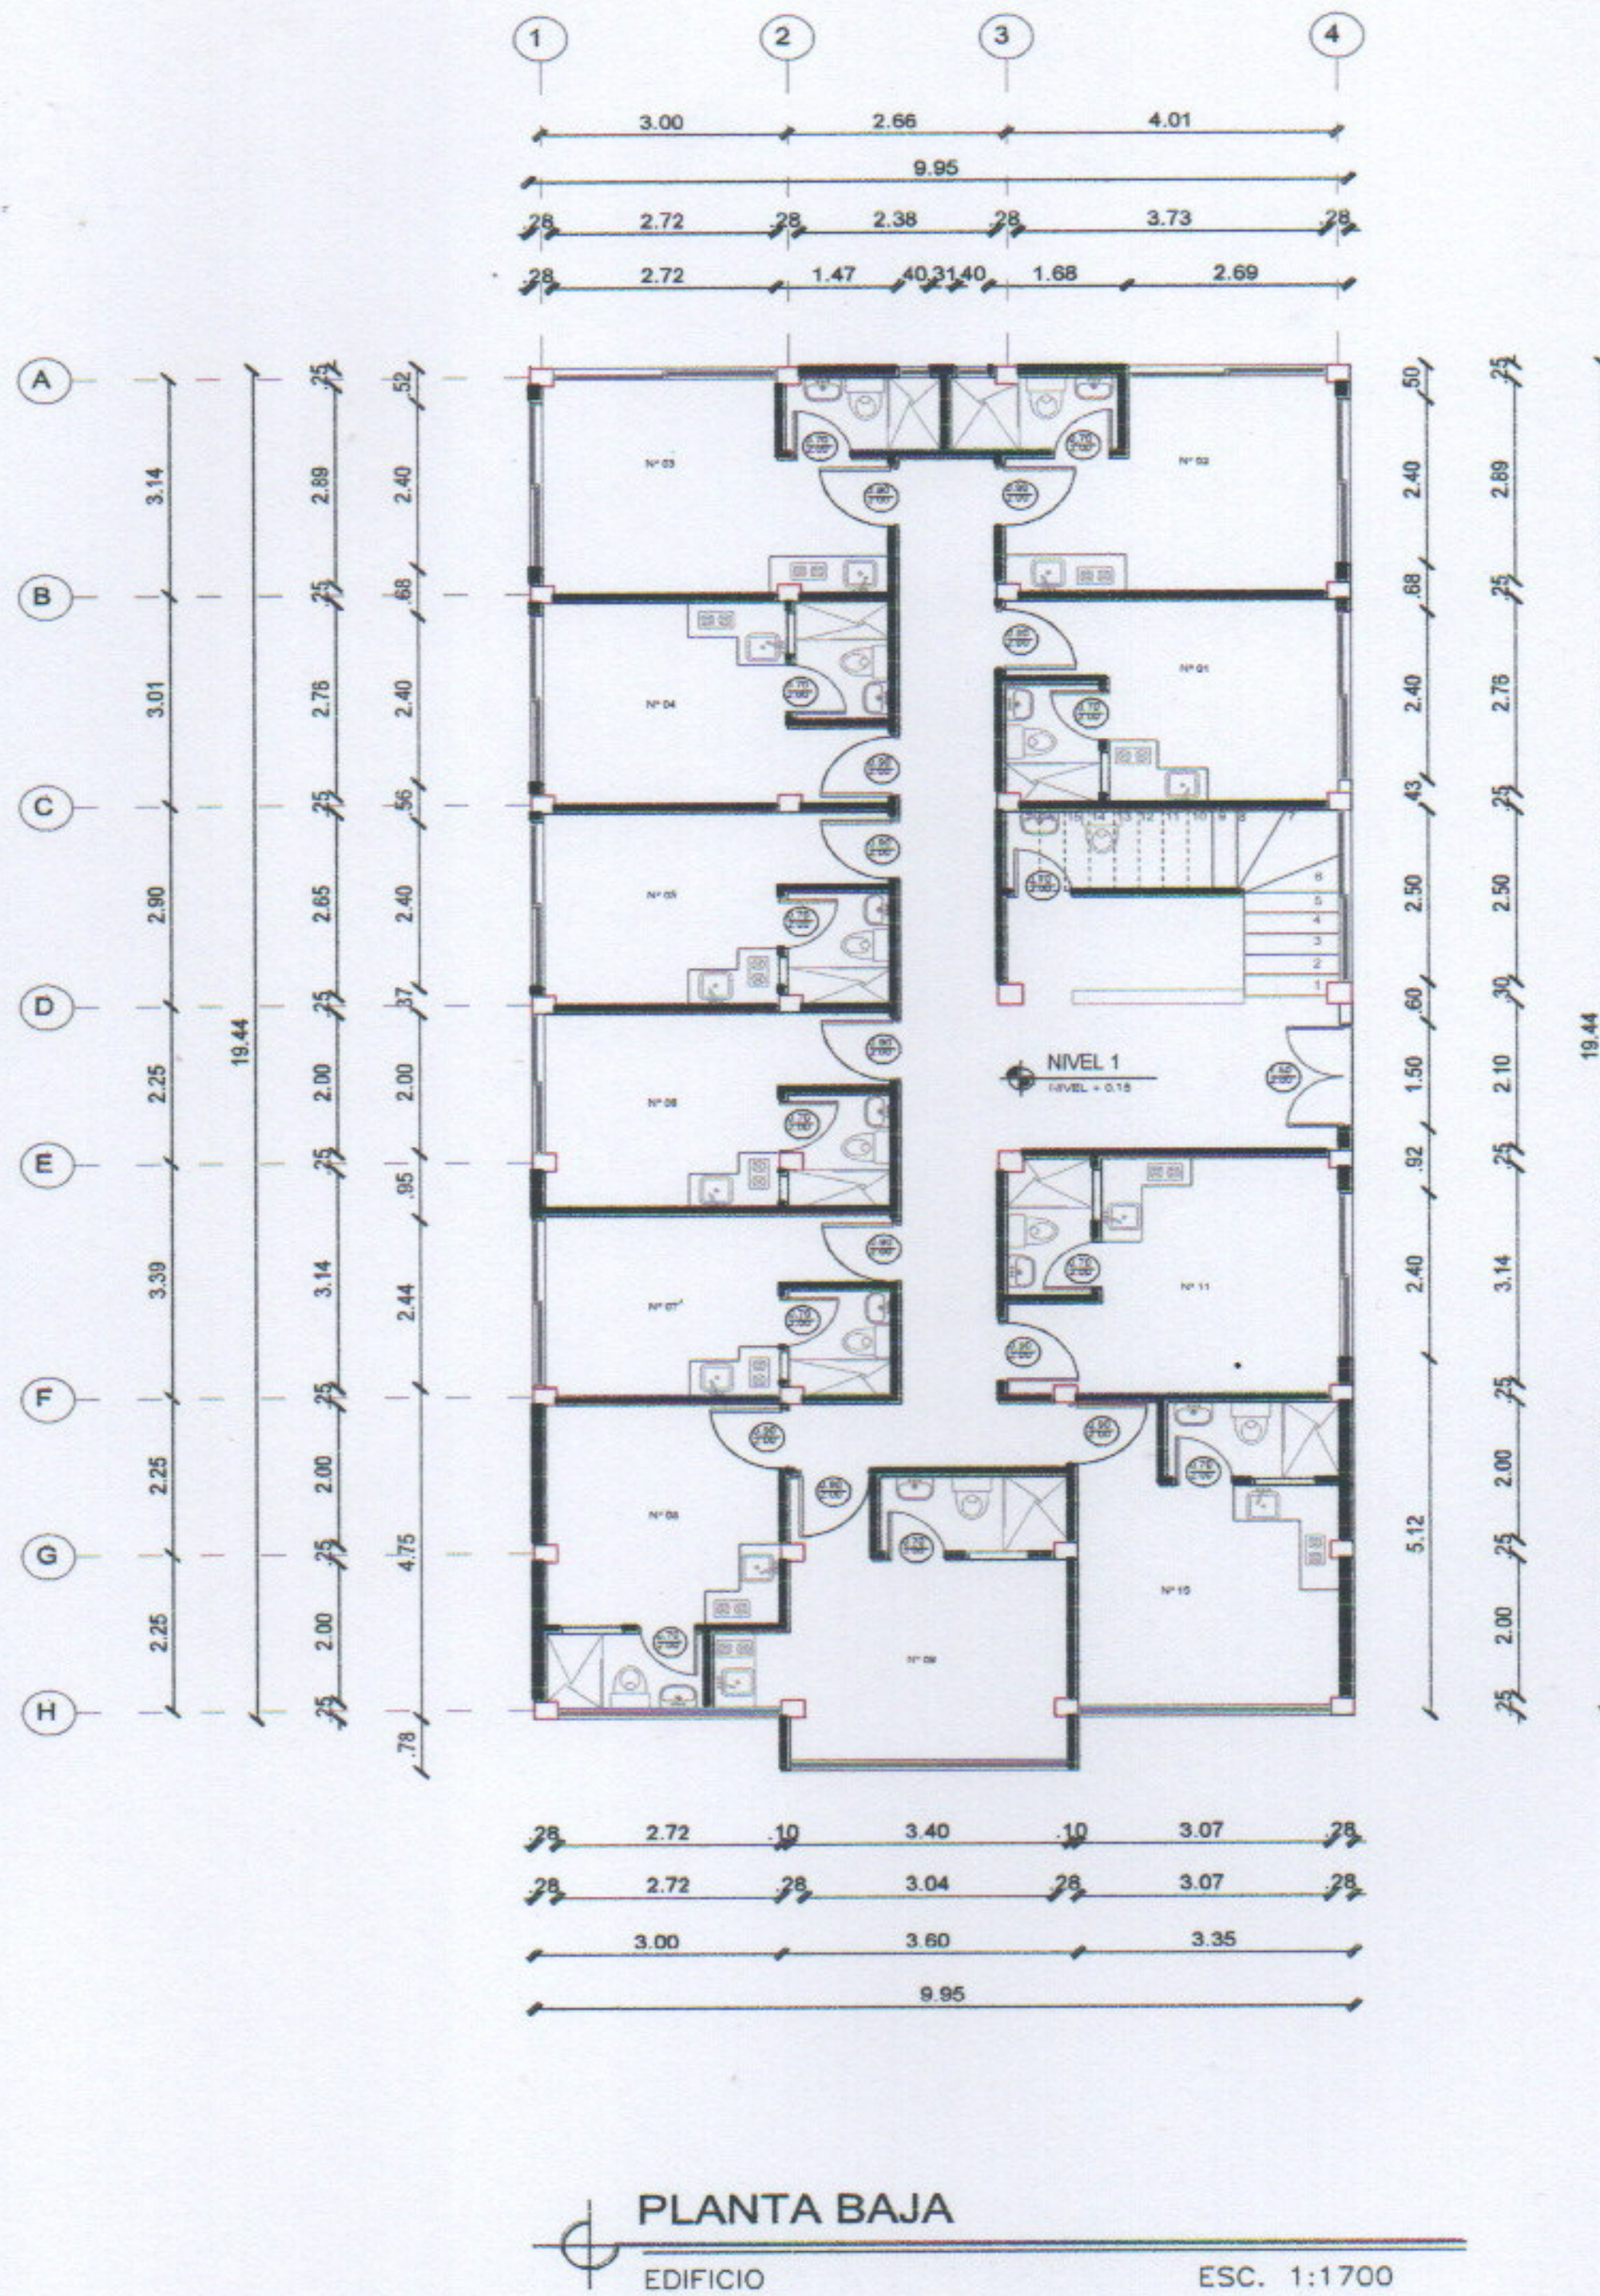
Planimetría de la planta baja del Edificio The trio
